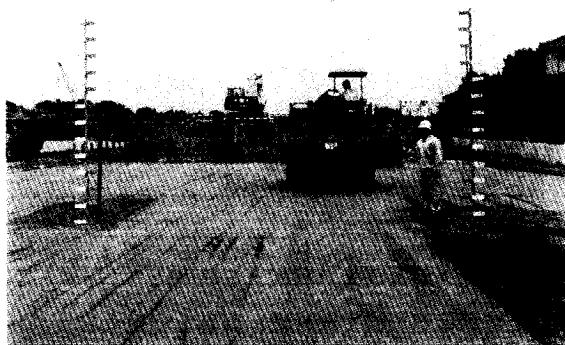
タイヤローラによる締固の状況（北陸地方建設局）
